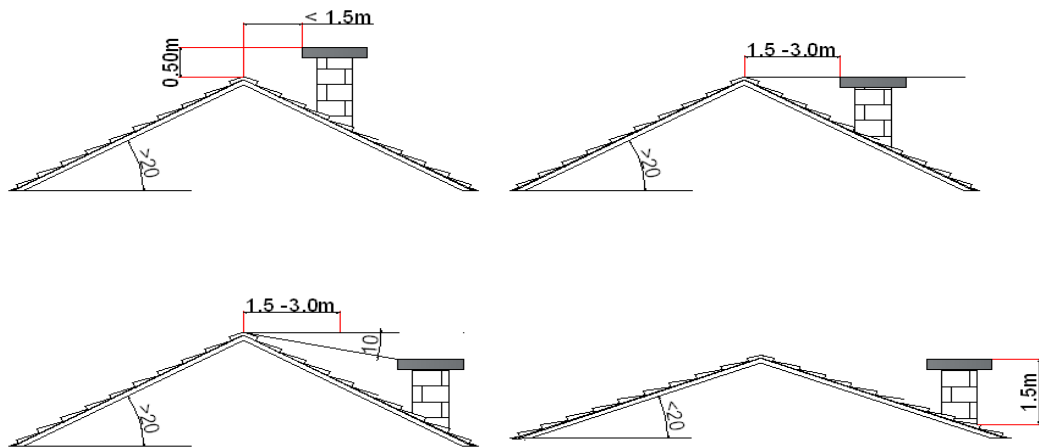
Colocacion adecuada de lachimenea sobre el techo
